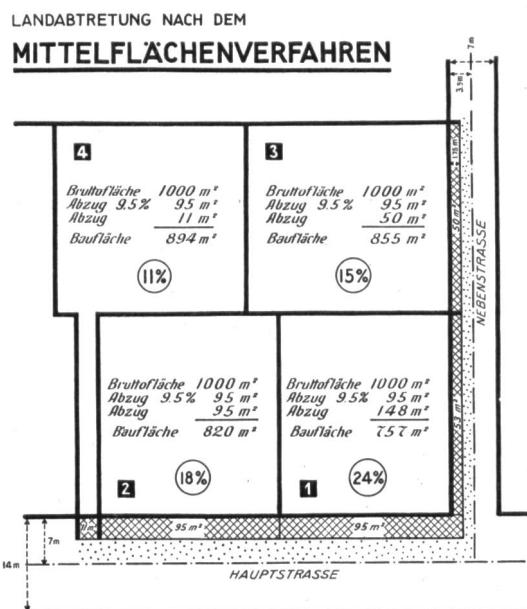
Bei Landabtretung nach dem Mittelflächenverfahren wird die halbe Strassenfläche proportional den Grundstückgrössen, die andere nach der Frontlänge abgetreten. (Siehe auch «Plan»-Nr. 6/1949, S. 184.)
